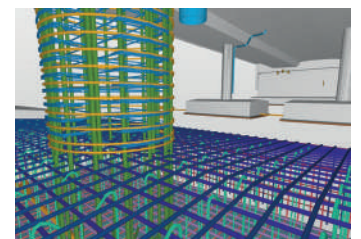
Modelo BIM – Secção do tabuleiro e ligação do fuste do pilar à sapata. BIM model – Deck cross section and connection between pier shaft and foundation.
